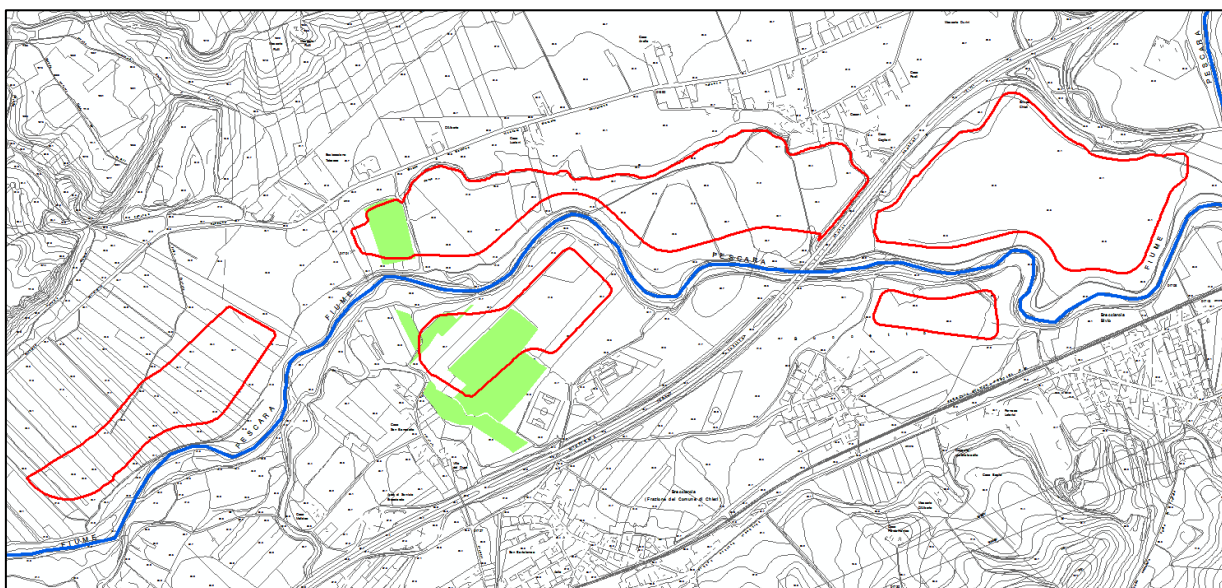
Planimetria con ubicazione delle aree (in verde) oggetto di passate attività di cava e interessate dai lavori. In rosso i perimetri delle arginature delle casse di espansione.
